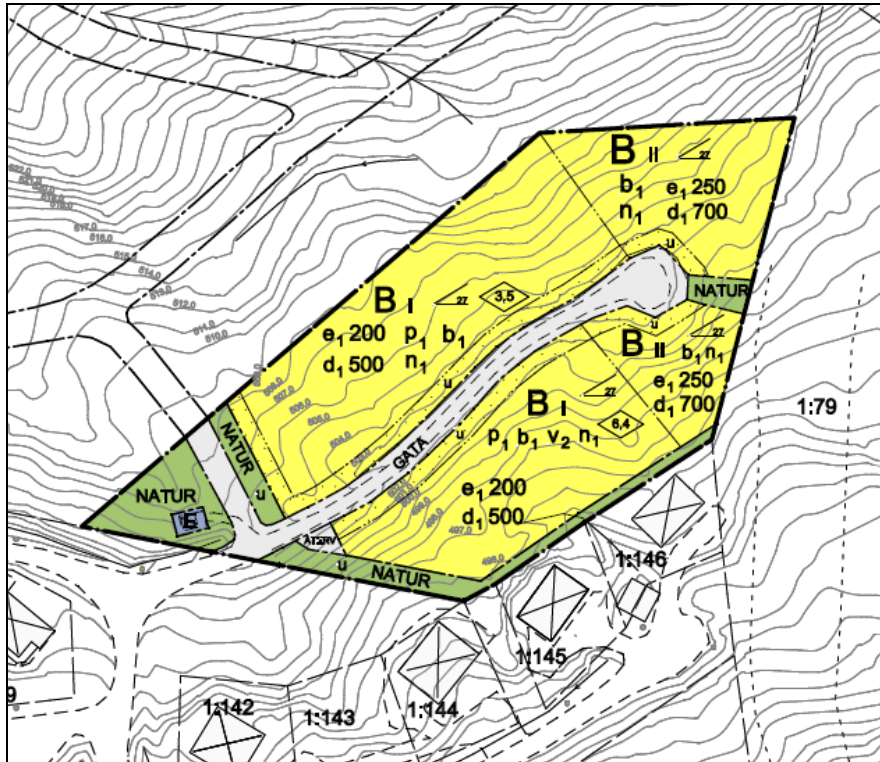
Utdrag från plankarta, Detaljplan för del av fastigheten Laxnäs 1:123, laga kraft 2017 (bet. 2421-P2017/1)
